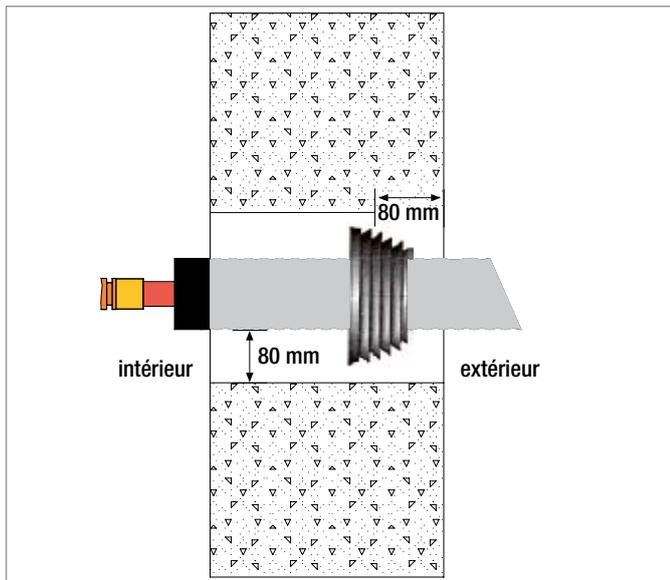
, Joint d'étanchéité mural dentelé - Vue latérale, trou carroté
